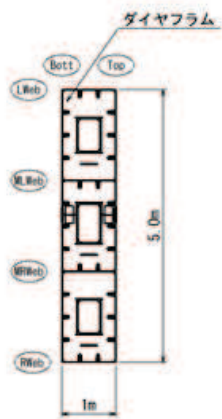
(2) 鋼製遮水壁 (鋼桁 2) 平面図
